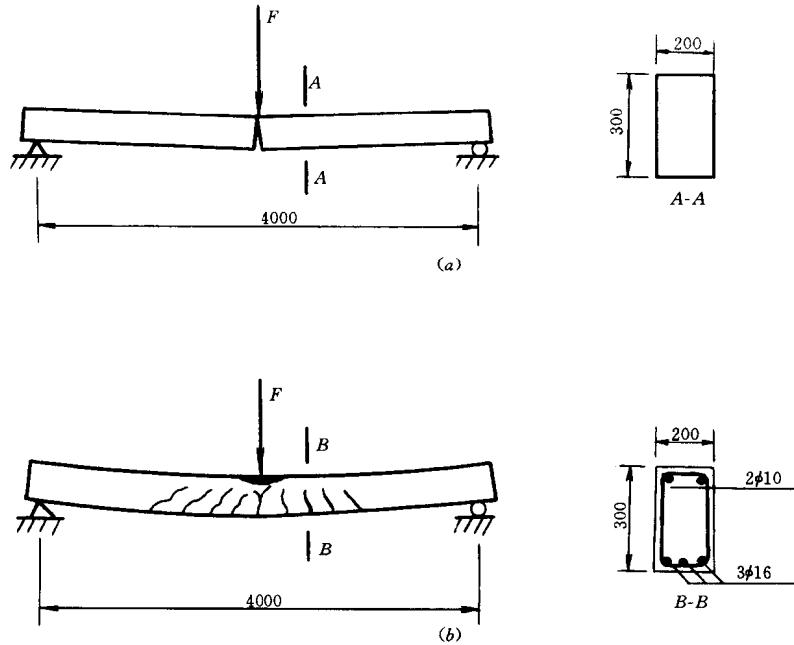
素混凝土梁与钢筋混凝土梁的破坏情况对比
